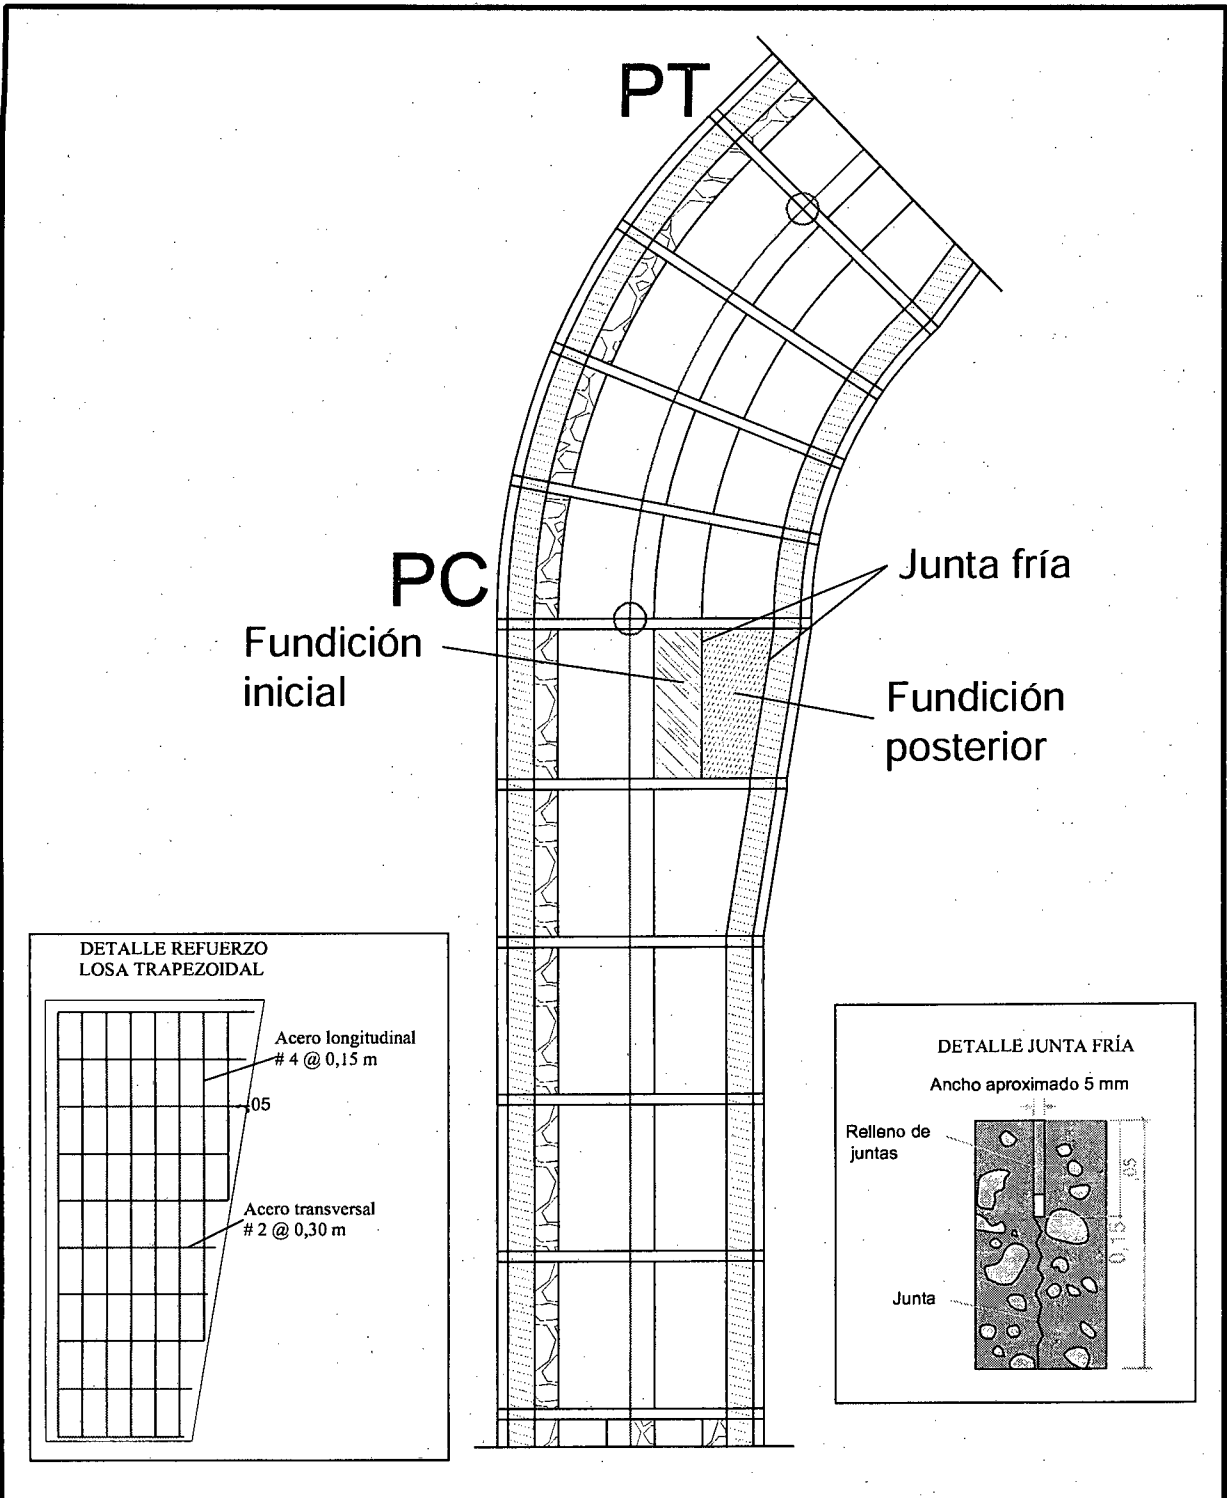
Vista en planta de la modulación de placas-huella y riostras en la curva TIPO 10
